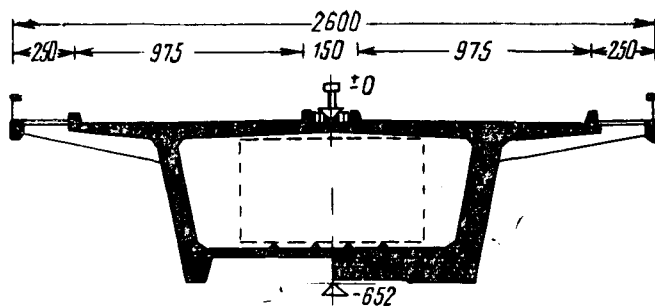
Поперечное сечение пролетного строения моста через Нусельскую долину
